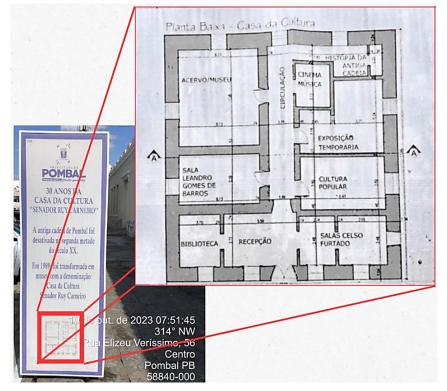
Planta baixa da Casa da Cultura em painel da calçada da edificação.
